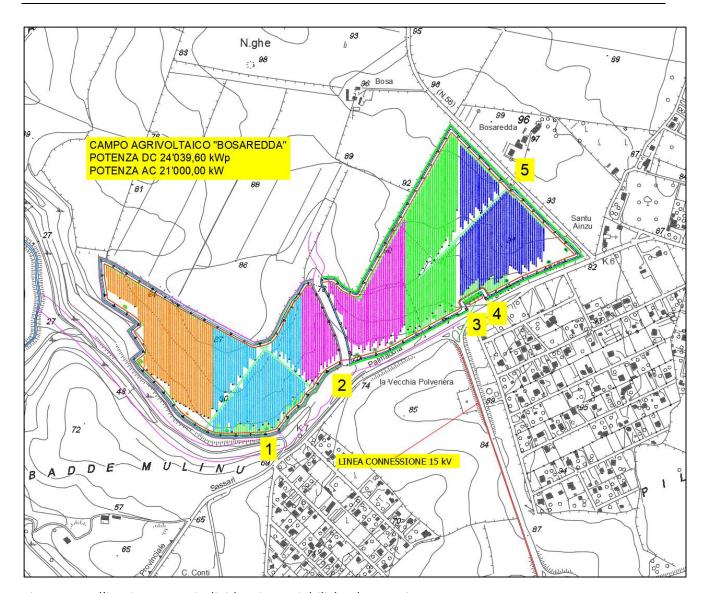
Area d'impianto con individuazione viabilità ed accessi
